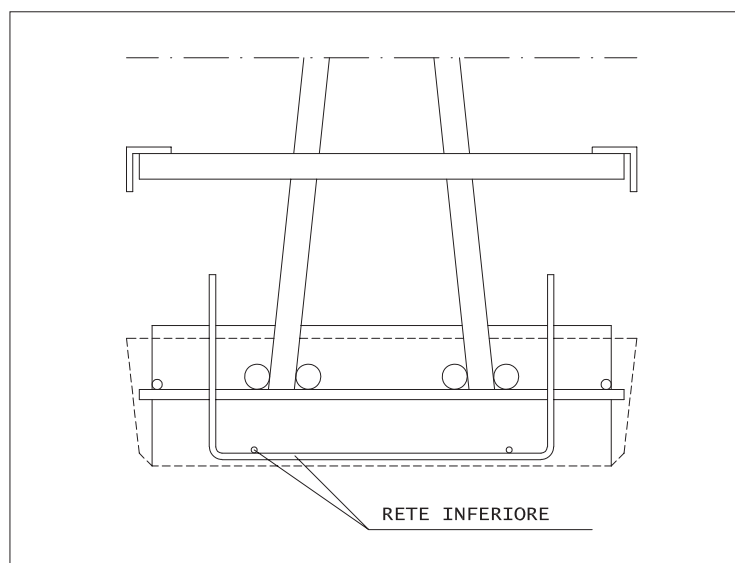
Rete inferiore nei fondelli in calcestruzzo.
